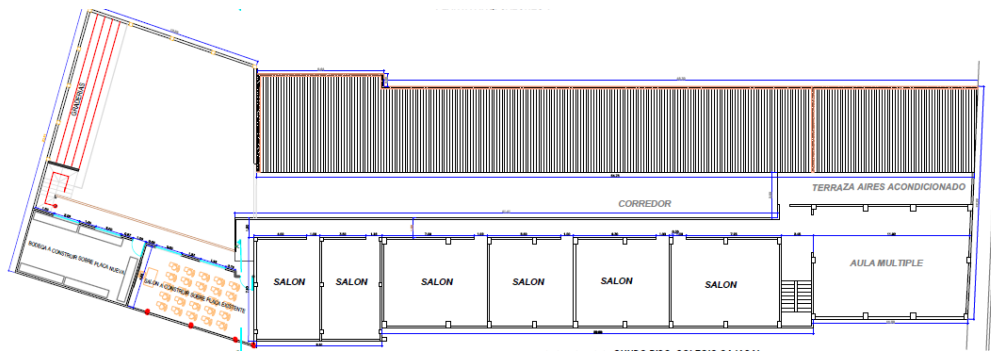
Planta 2º Piso Colegio. Nueva. CAJASAI.
